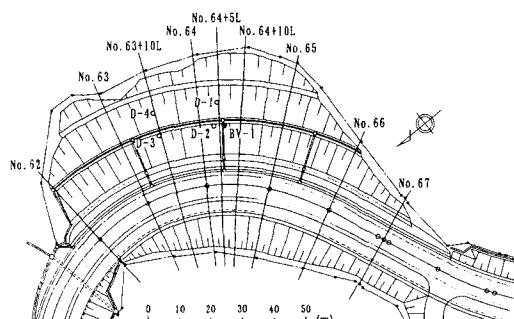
調査対象地点平面図（切り勾配 1 : 1.5）
